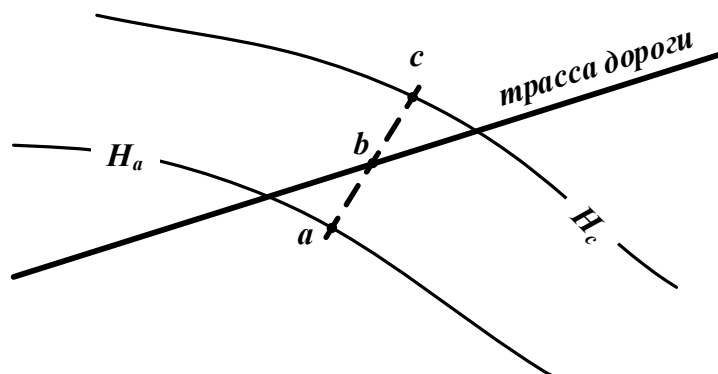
Определение высотных отметок по плану в горизонталях
